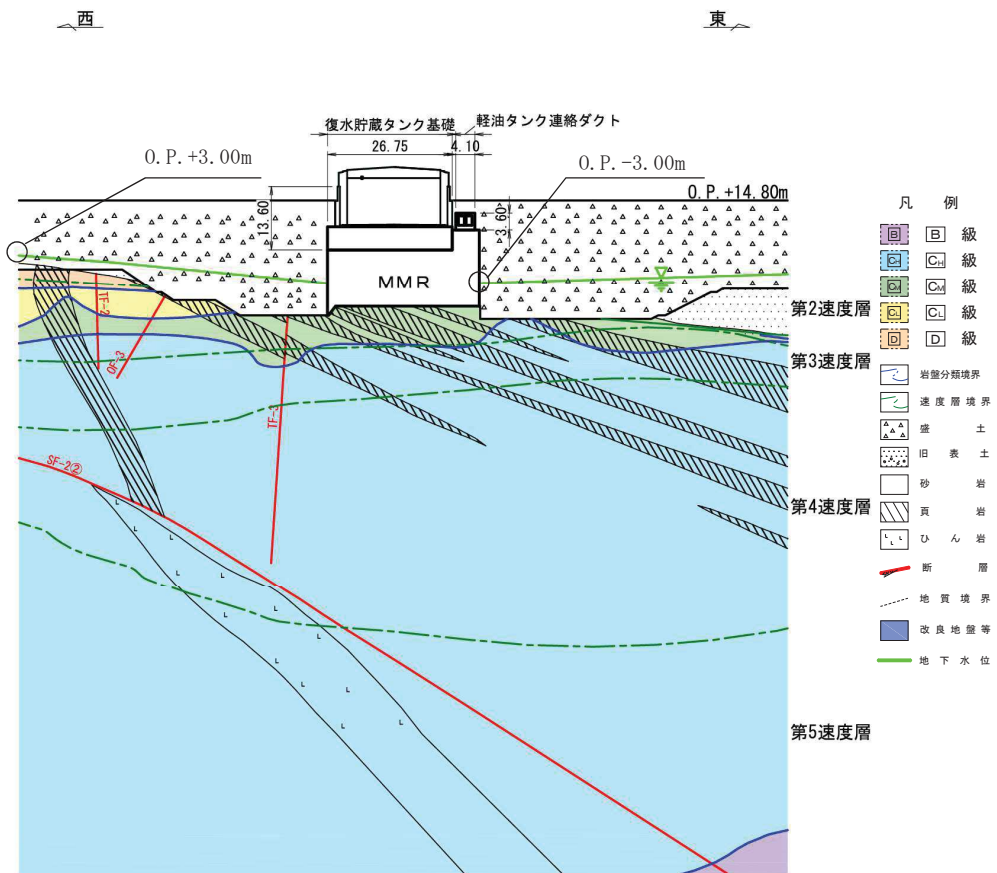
復水貯蔵タンク基礎 地震時荷重算出用地質出断面図 (B-B 断面, 東西)
